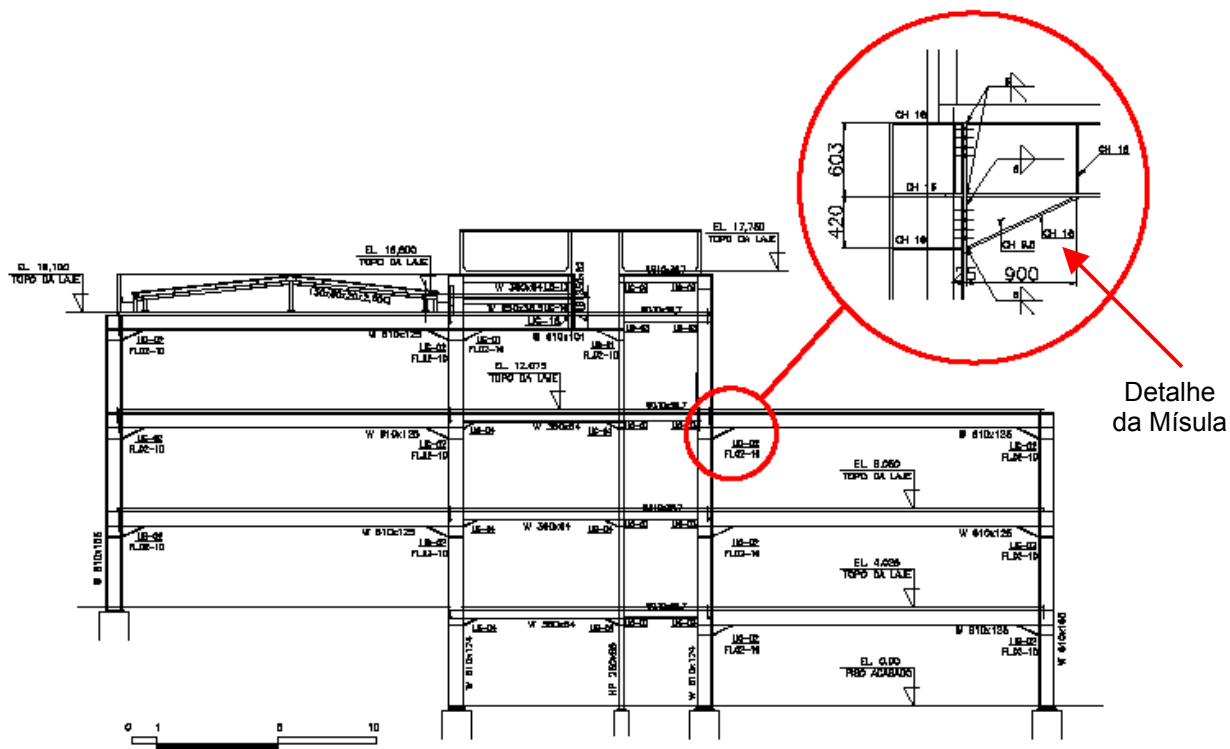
Elevação do projeto estrutural e detalhe da ligação onde se encontra a mísula. (Fonte: adaptado do projeto empresa EC-Ea).
